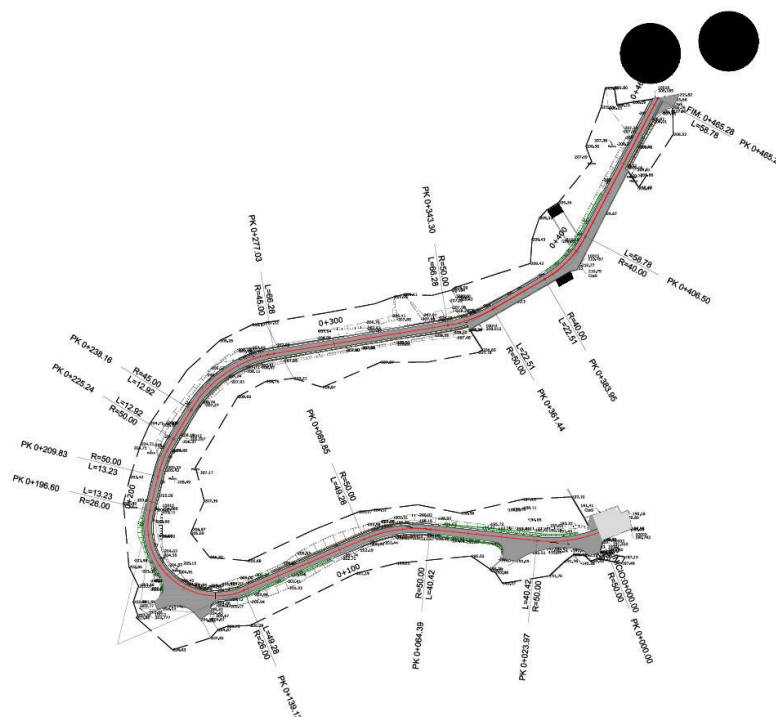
Traçado em planta – Acesso ao Reservatório de Cerite
